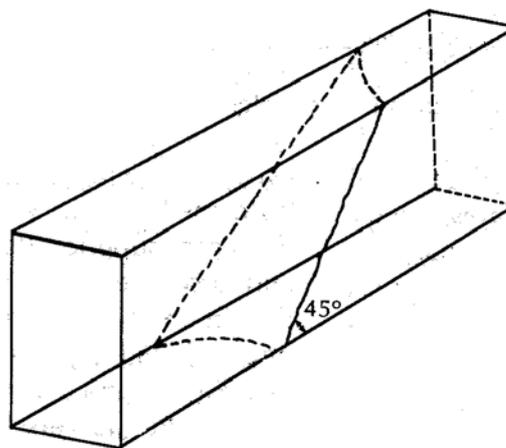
Superficie de falla de una viga de concreto simple.
